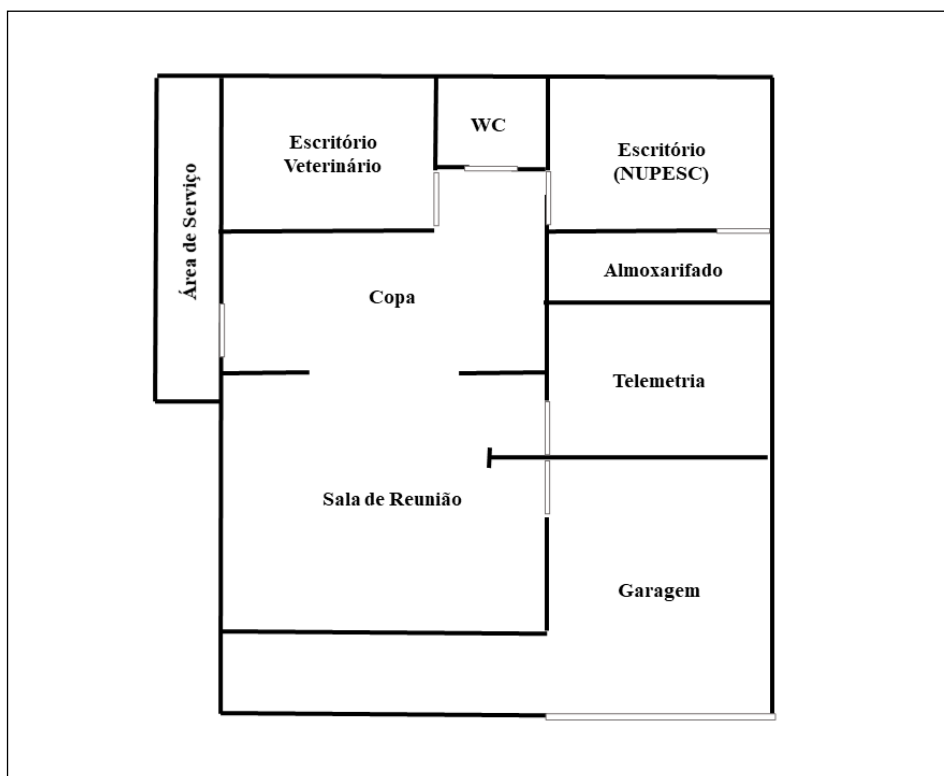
Planta baixa da base FMA Barra de Mamanguape-PB. Fonte: Arquivo Pessoal (2019).
